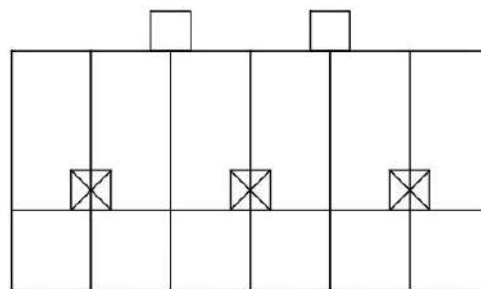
Rumah Susun Tipe Multiple Eksterior Access
